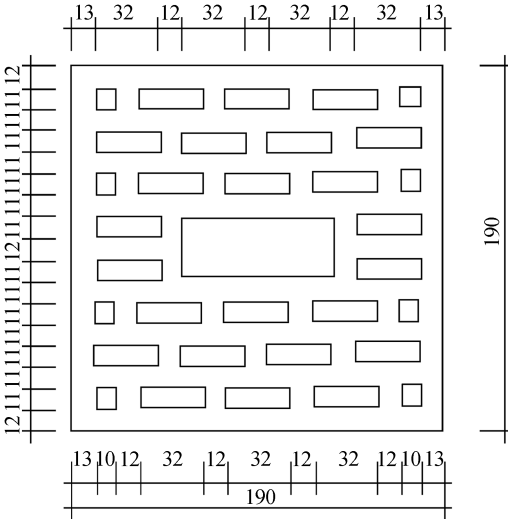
33 孔矩形孔煤矸石烧结多孔砖平面图
